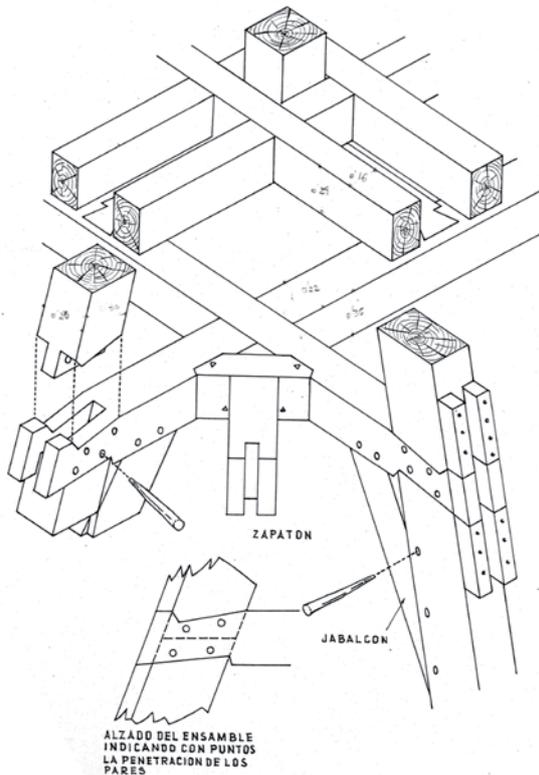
detalle de armado del chapitel de la torre de las damas del Monasterio del Escorial según Julio Vidaurre, entre 1963-1965. Archivo del departamento de arquitectura de Patrimonio Nacional
